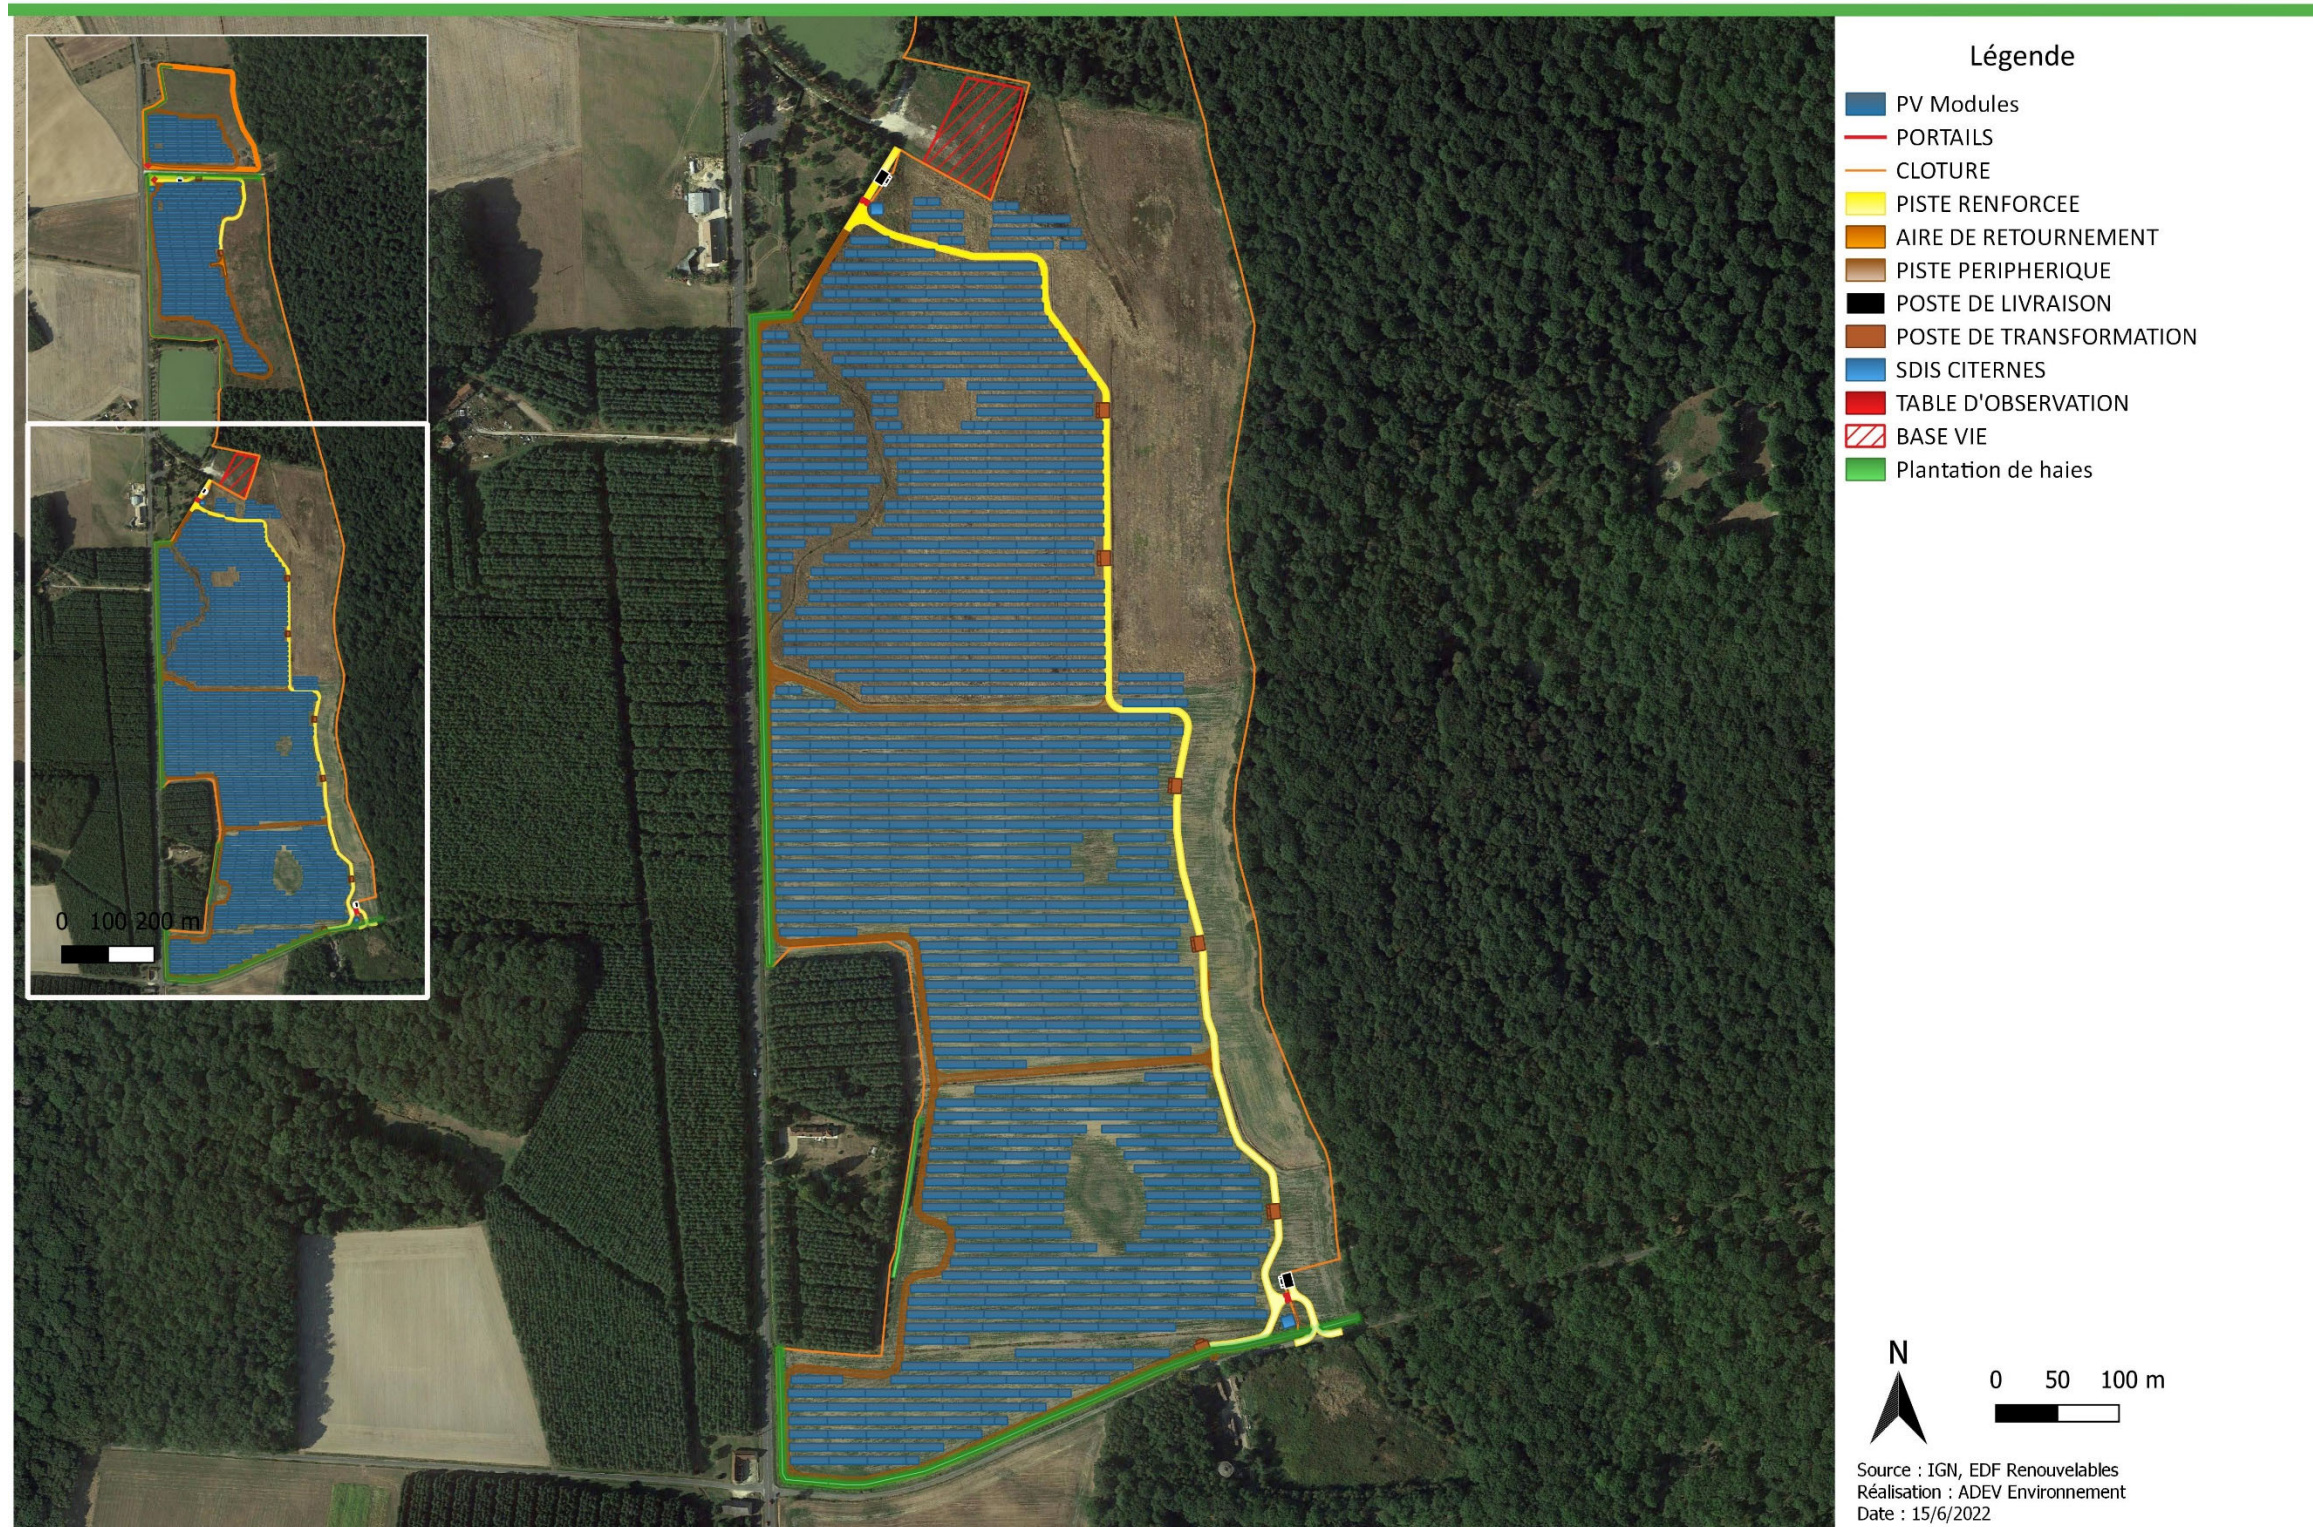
Plan de masse du projet photovoltaïque : zone sud
